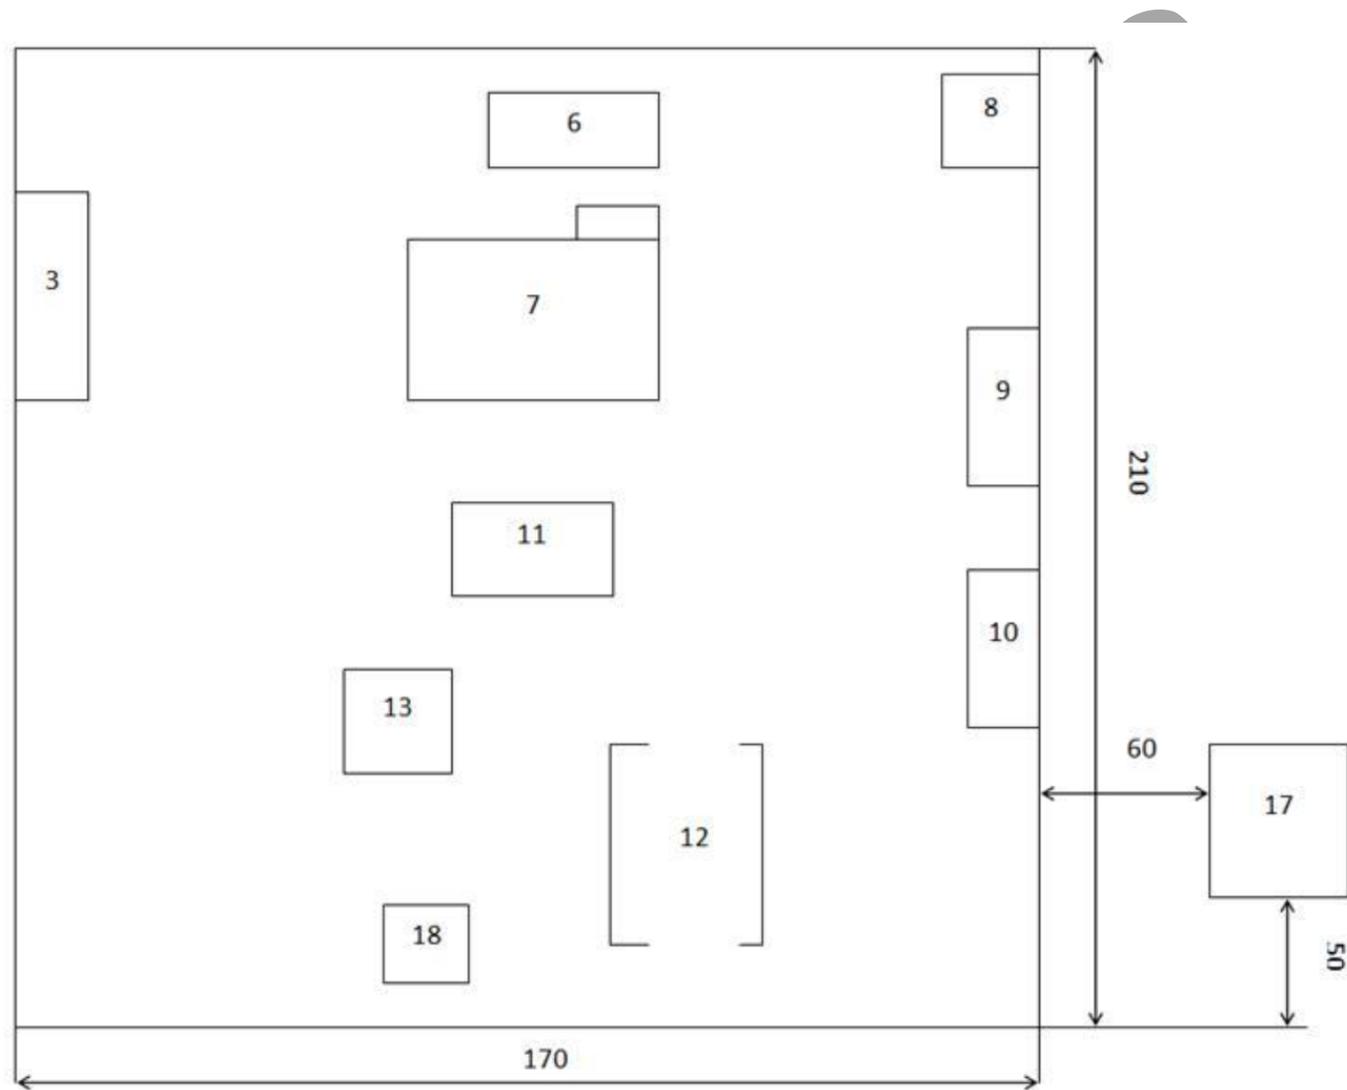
План расположения объектов водоснабжения ремонтного предприятия: 3 - цех оснастки; 6 - кузнечно-сварочный цех; 7 - производственный корпус; 8 - котельная; 9 - сервисный центр; 10 - материальный склад; 11 - механический цех; 12 - теплый гараж; 13 - прачечная; 17 - жилое здание; 18 – котельная
